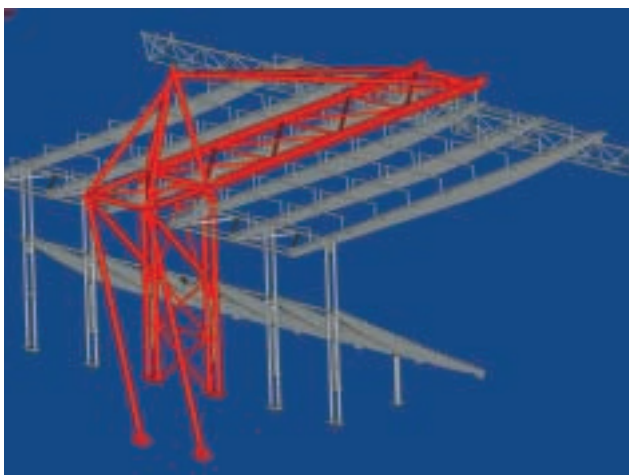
Vista assonometrica 3D del modulo strutturale
